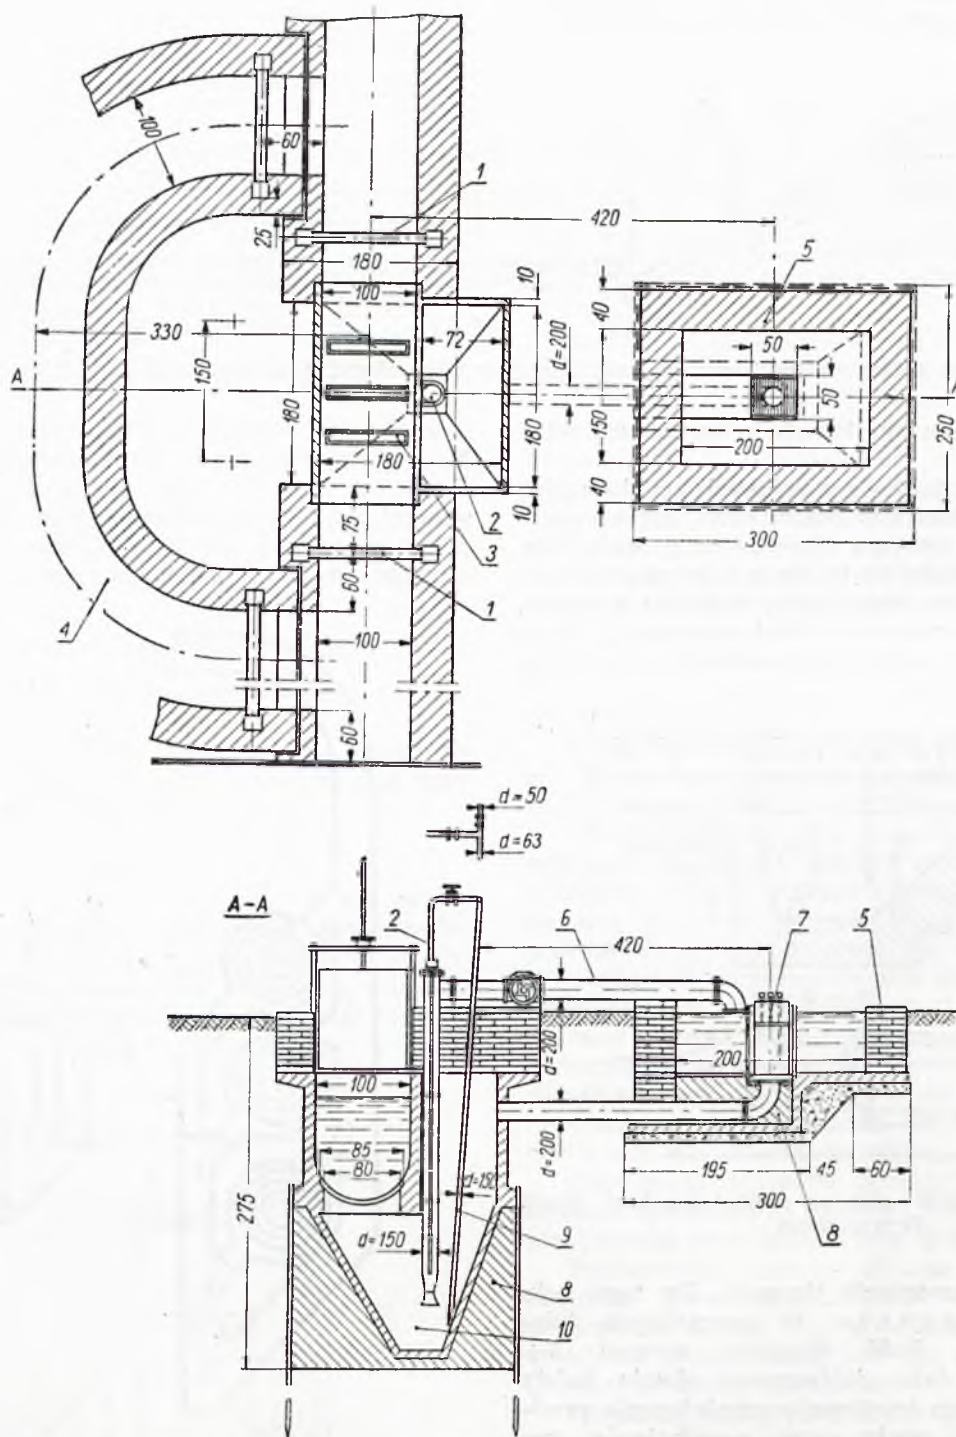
Piaskownik pionowy o stałej prędkości przepływu wody: a) plan, b) przekrój
